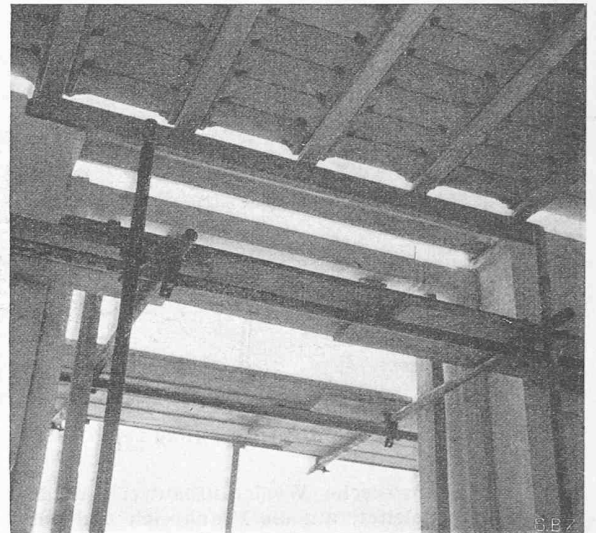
Boden aus Spannbeton-Elementen mit Löchern für die Deckenaufhängung
